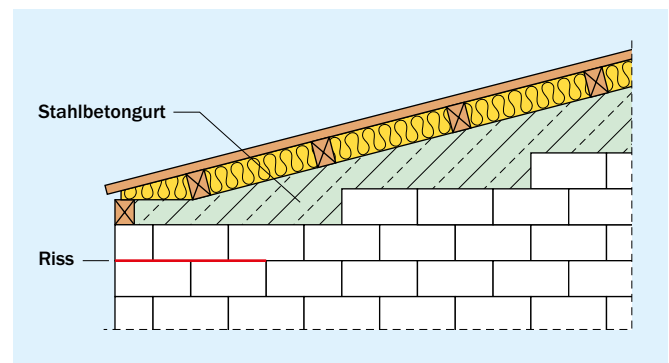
Stahlbetongurt auf Mauerwerks-Giebelwand
